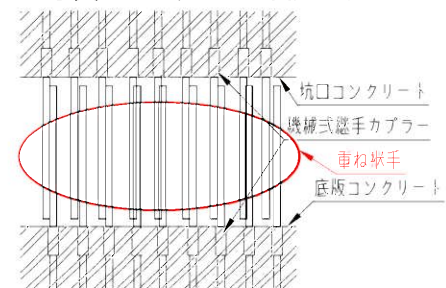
原設計坑口平面・断面図 図－4 変更後坑口平面・断面図
